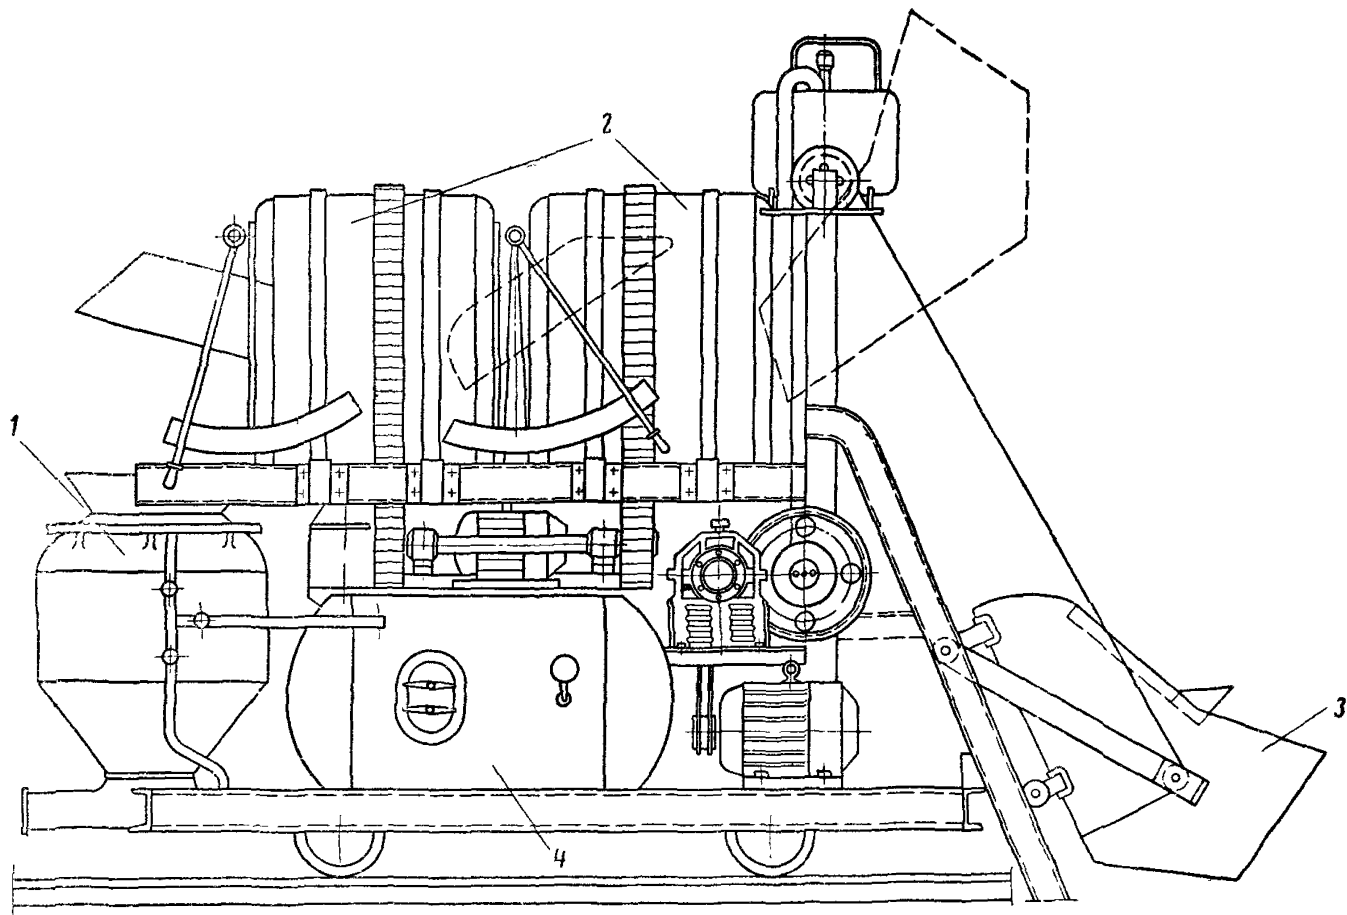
Бетонукладочный агрегат с пневмобетонагнетателем:
